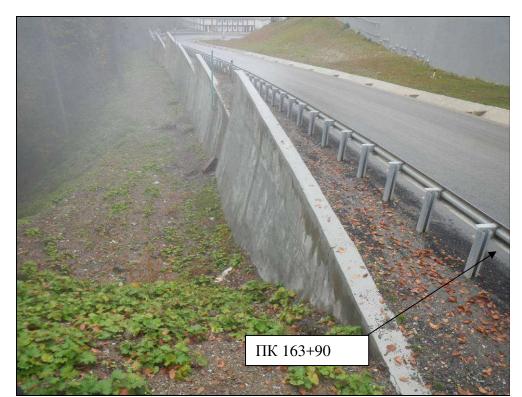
Фрагмент подпорной стены СТ-74. Фото от ПК 163+90
